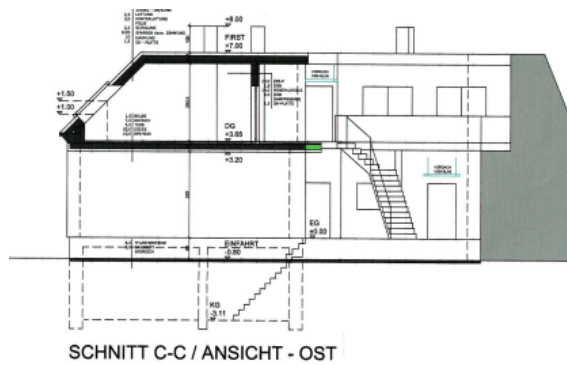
Schnitt (Auswechslungsplan 28.02.2014)
